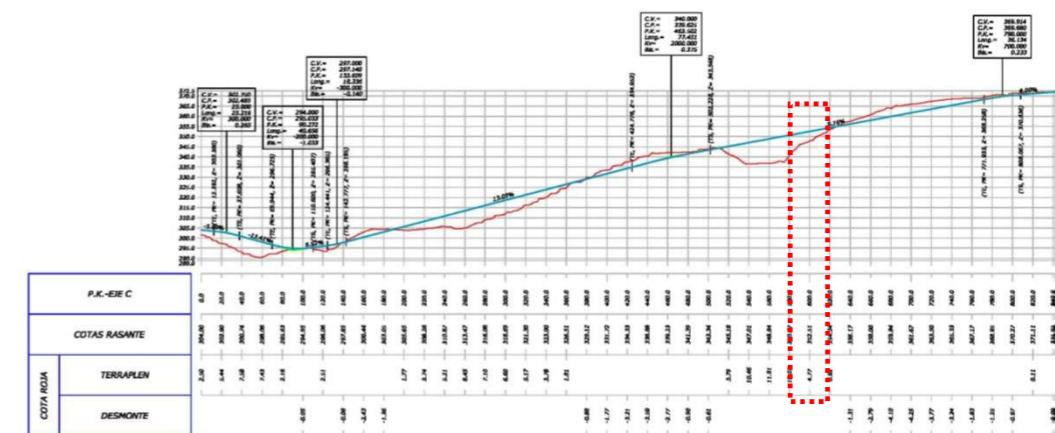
Detalle de perfil longitudinal red vial eje C (Plan Parcial Maguenes. Plano O-6)
